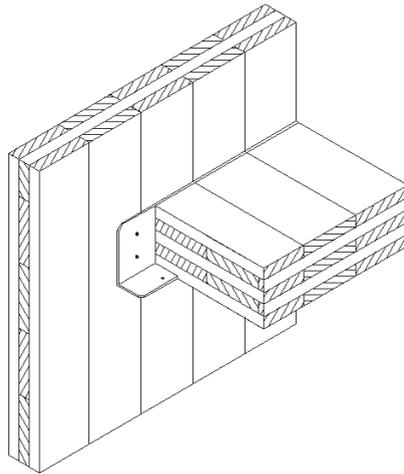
Appoggio del solaio di interpiano su parete continua: collegamento mediante angolare metallico avvitato alla parete
